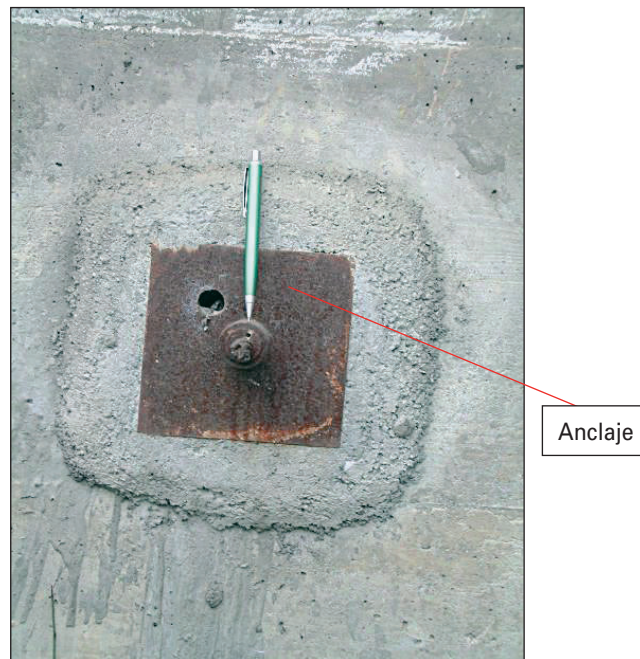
ANCLAJES ESTRIBO/TERRENO.
